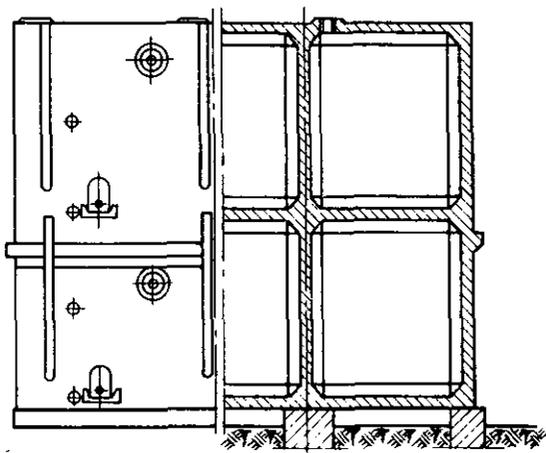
Двухъярусные прямоугольные железобетонные резервуары.
